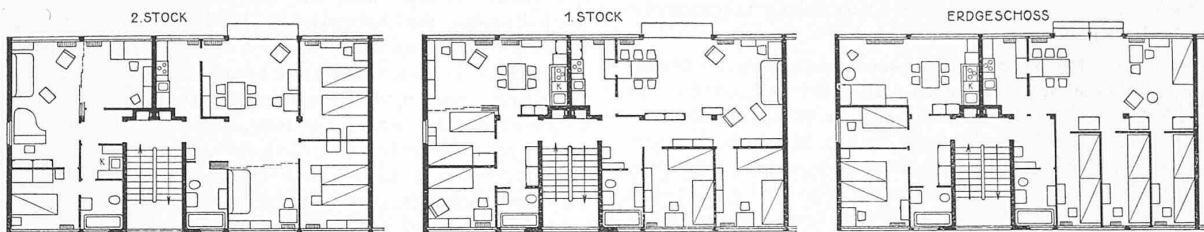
Grundrisse der sechs Wohnungen der Schweizer-Gruppe im Miethausblock M. v. d. Rohe, Stuttgart 1927. — Masstab 1 : 300.
